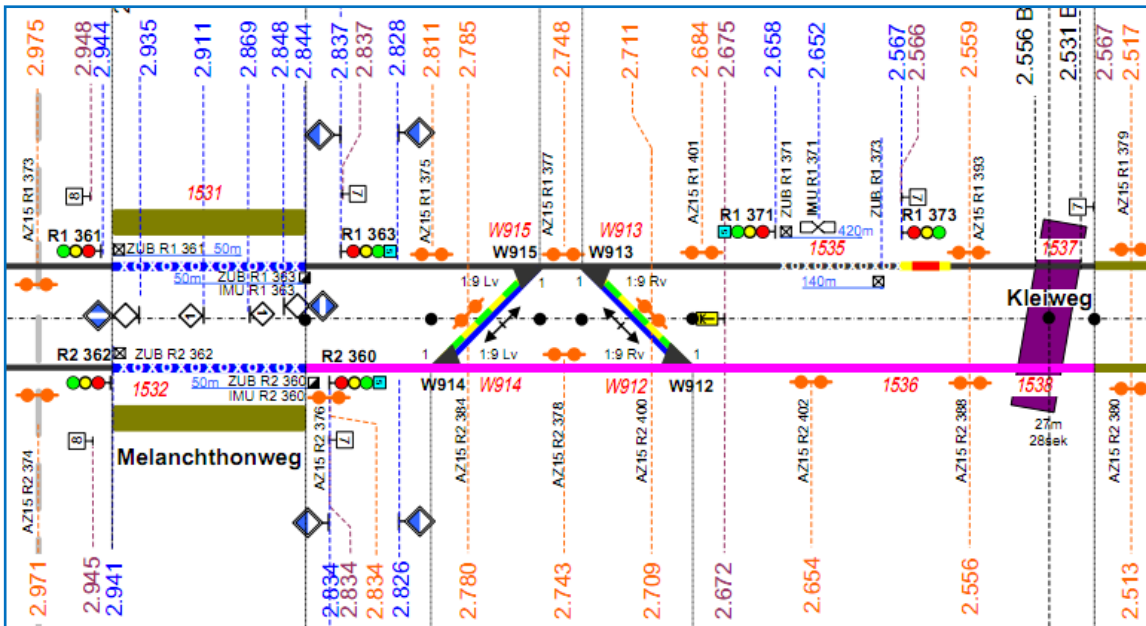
, Overzichtstekening type baan (tunnel, viaduct, onderdoorgang en aarden baan).
